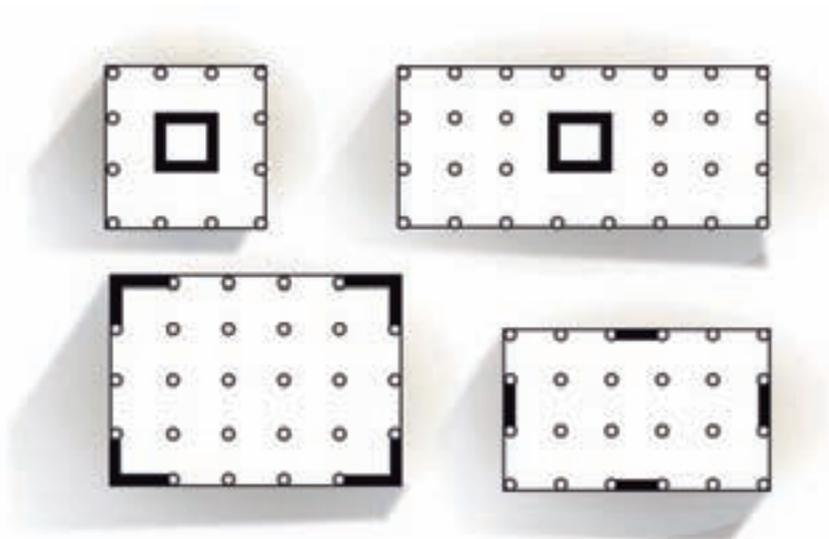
Murs en rez-de-chaussée destinés à prévenir l'effet de niveau souple
